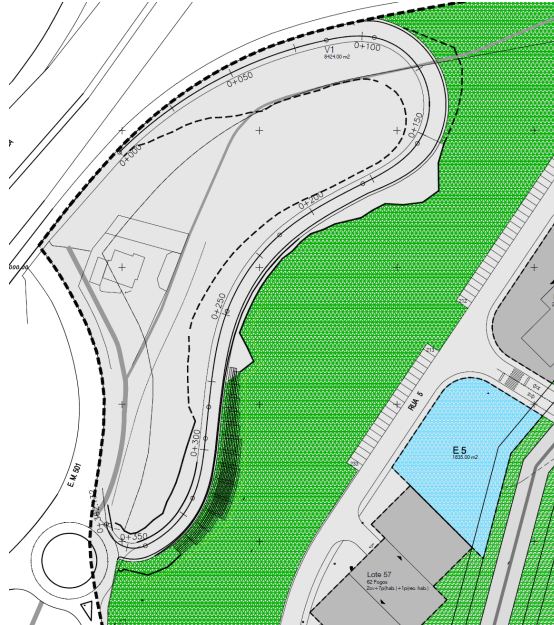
Planta de Cedências da solução proposta do mesmo local.
